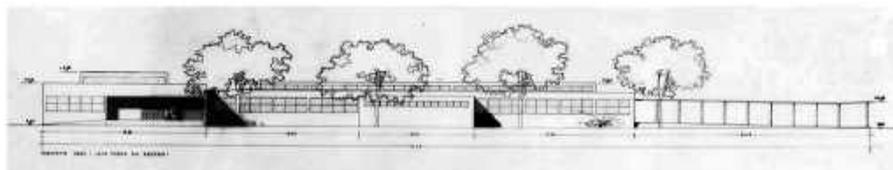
Prospetto nord, ingresso su via Bezzecca
